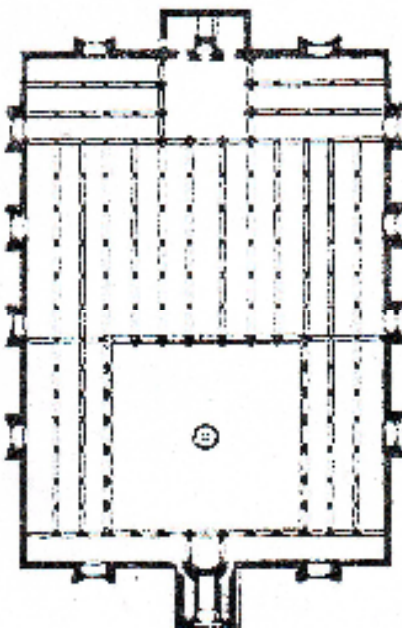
مسقط أفقي لجامع ابن صالح بمراكش.
